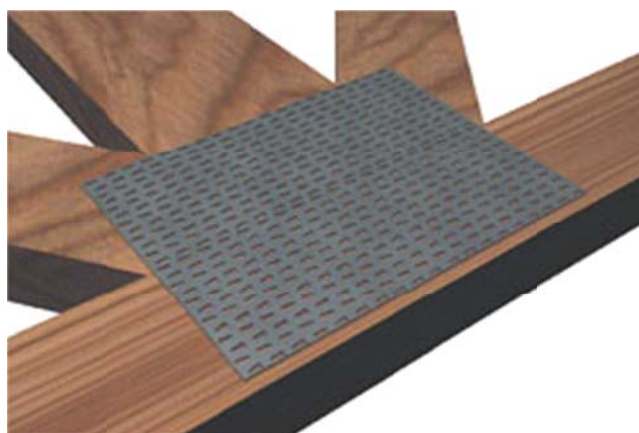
Узел соединения дощатых ферм на МЗП
